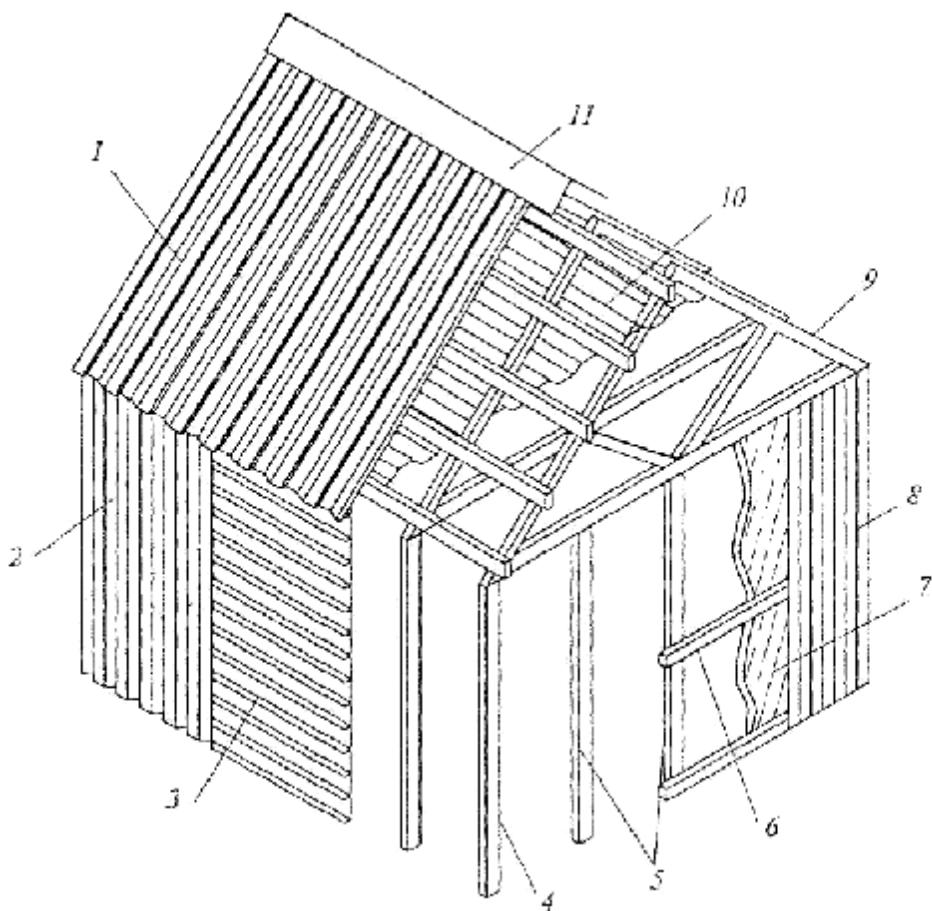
Б. Возможные варианты применения профнастила в зданиях: 1 — профнастил в конструкции кровли; 2, 8 — наружная обшивка стены профлистом; 3 — внутренняя обшивка стены кассетным профлистом; 4 — колонны каркаса; 5 — стойка стеновая; 6 — ригель стеновой; 7 — внутренняя обшивка (стеновой профнастил, гипсокартон, ОСП, ДСП и т.п.); 9 — стропильная ферма; 10 — профнастил чердачного перекрытия; 11 — коньковый профиль
